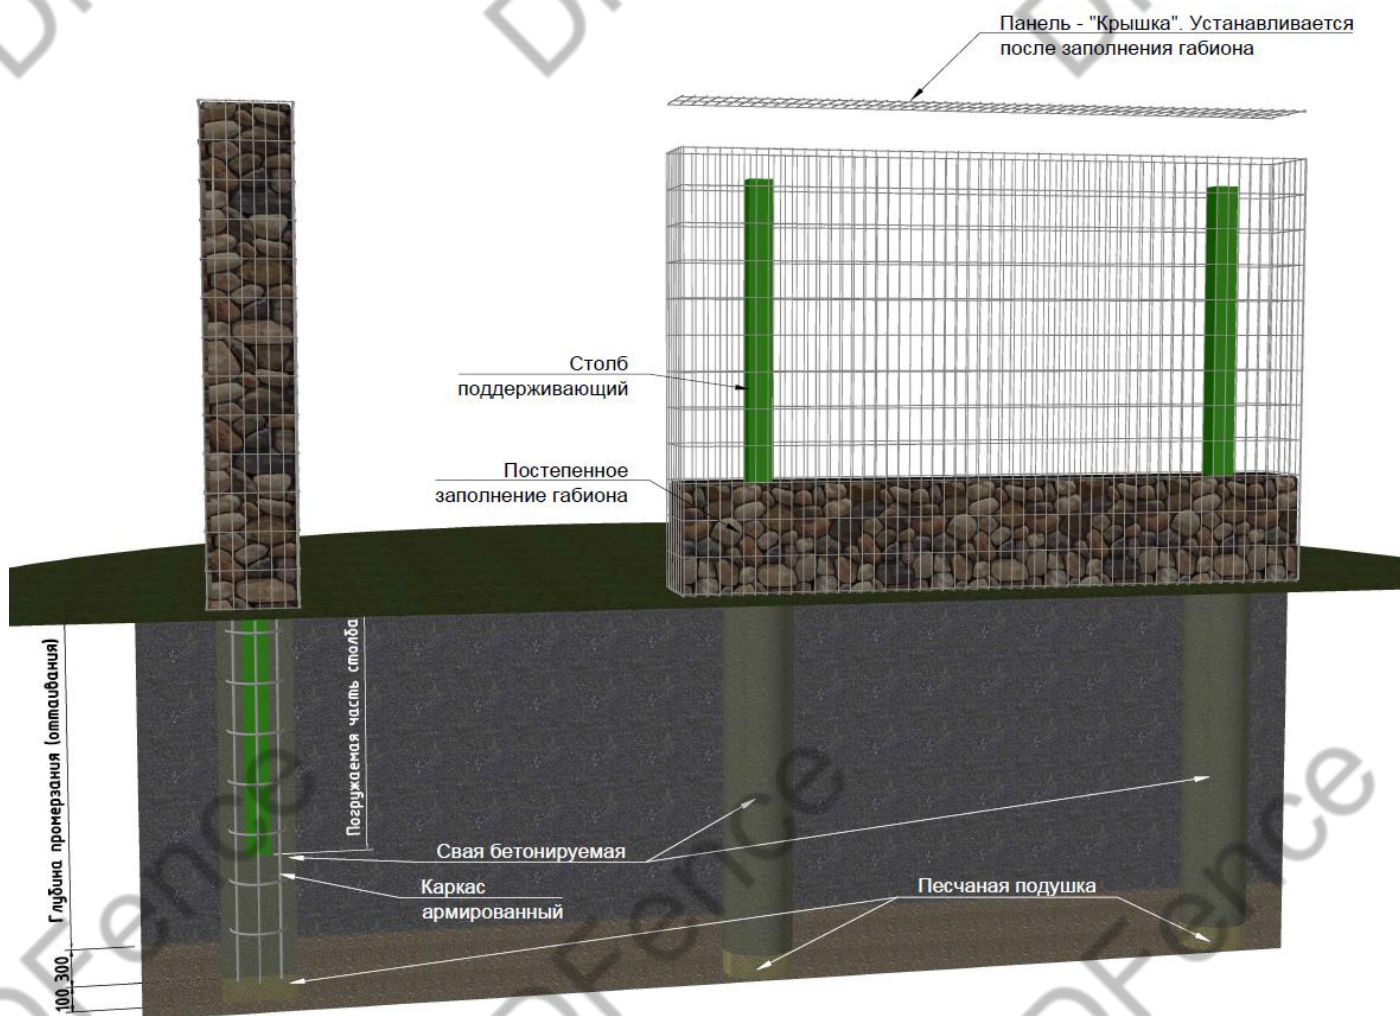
Устройство габиона с бетонируемыми поддерживающими столбами.
